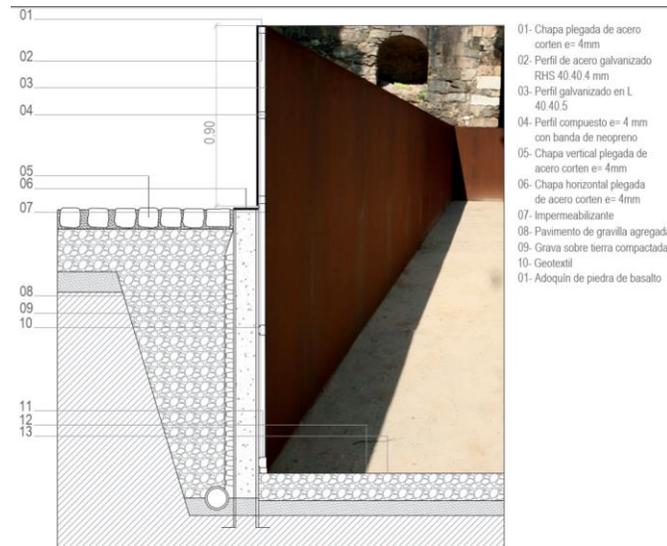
Fotomontaje de detalle constructivo muro de contención con recubrimiento de acero corten
